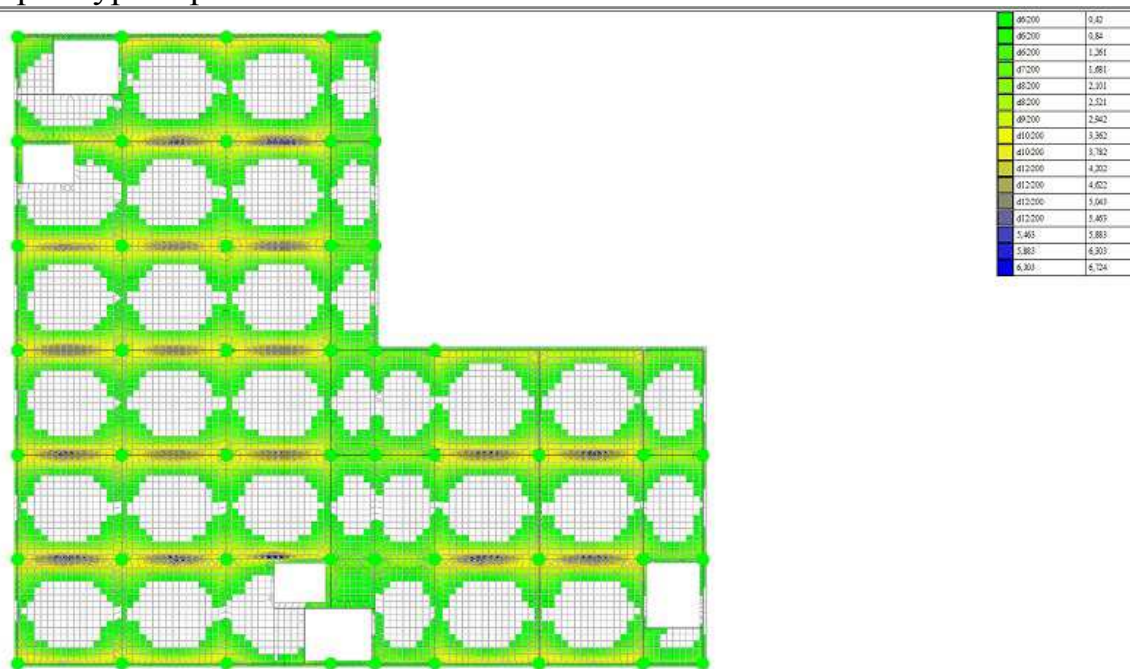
Схема верхнего армирования плиты по оси y
